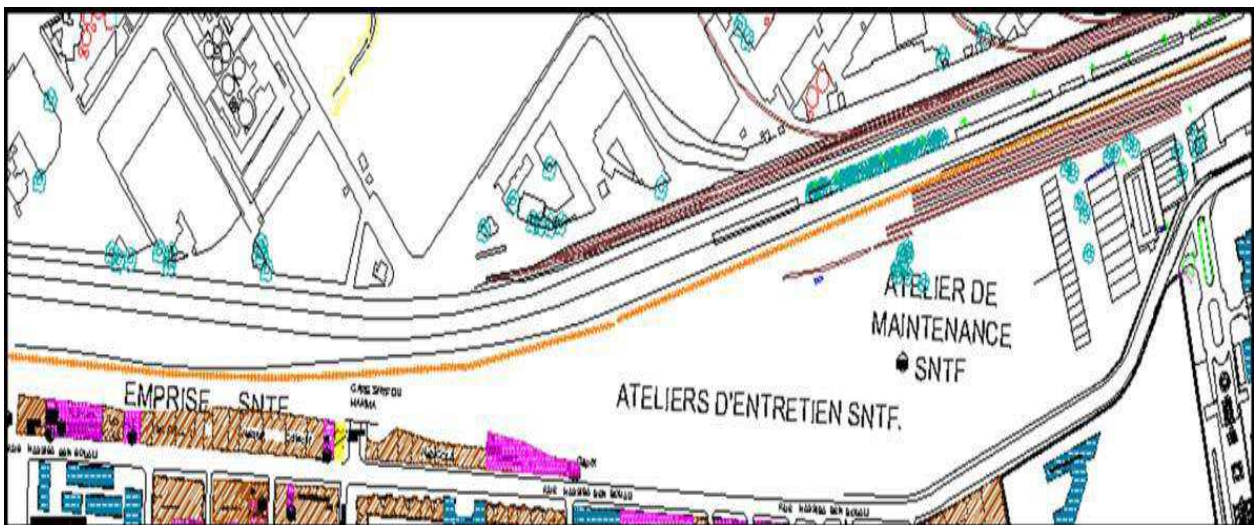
Plan de masse de la SNTF avant l'intervention.
